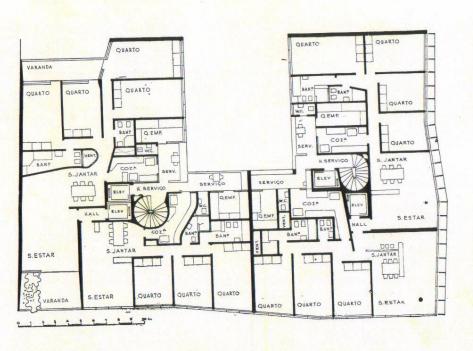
Planta baixa pav. tipo edifícios Finúsia e Dona Fátima
